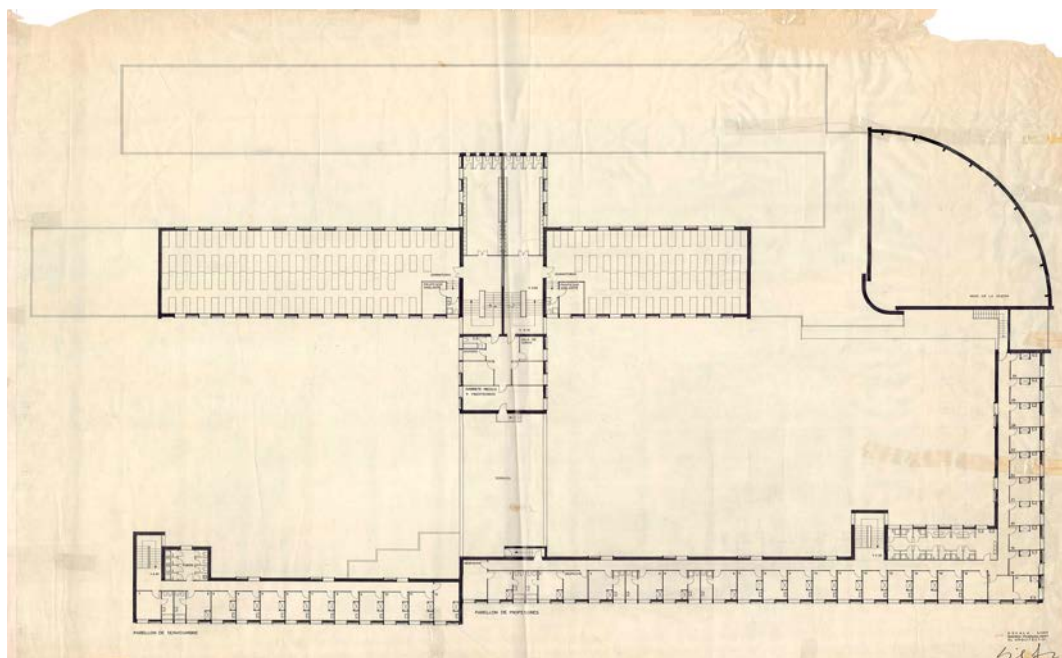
Planta primera. Proyecto. (AFF, sig. 152).
